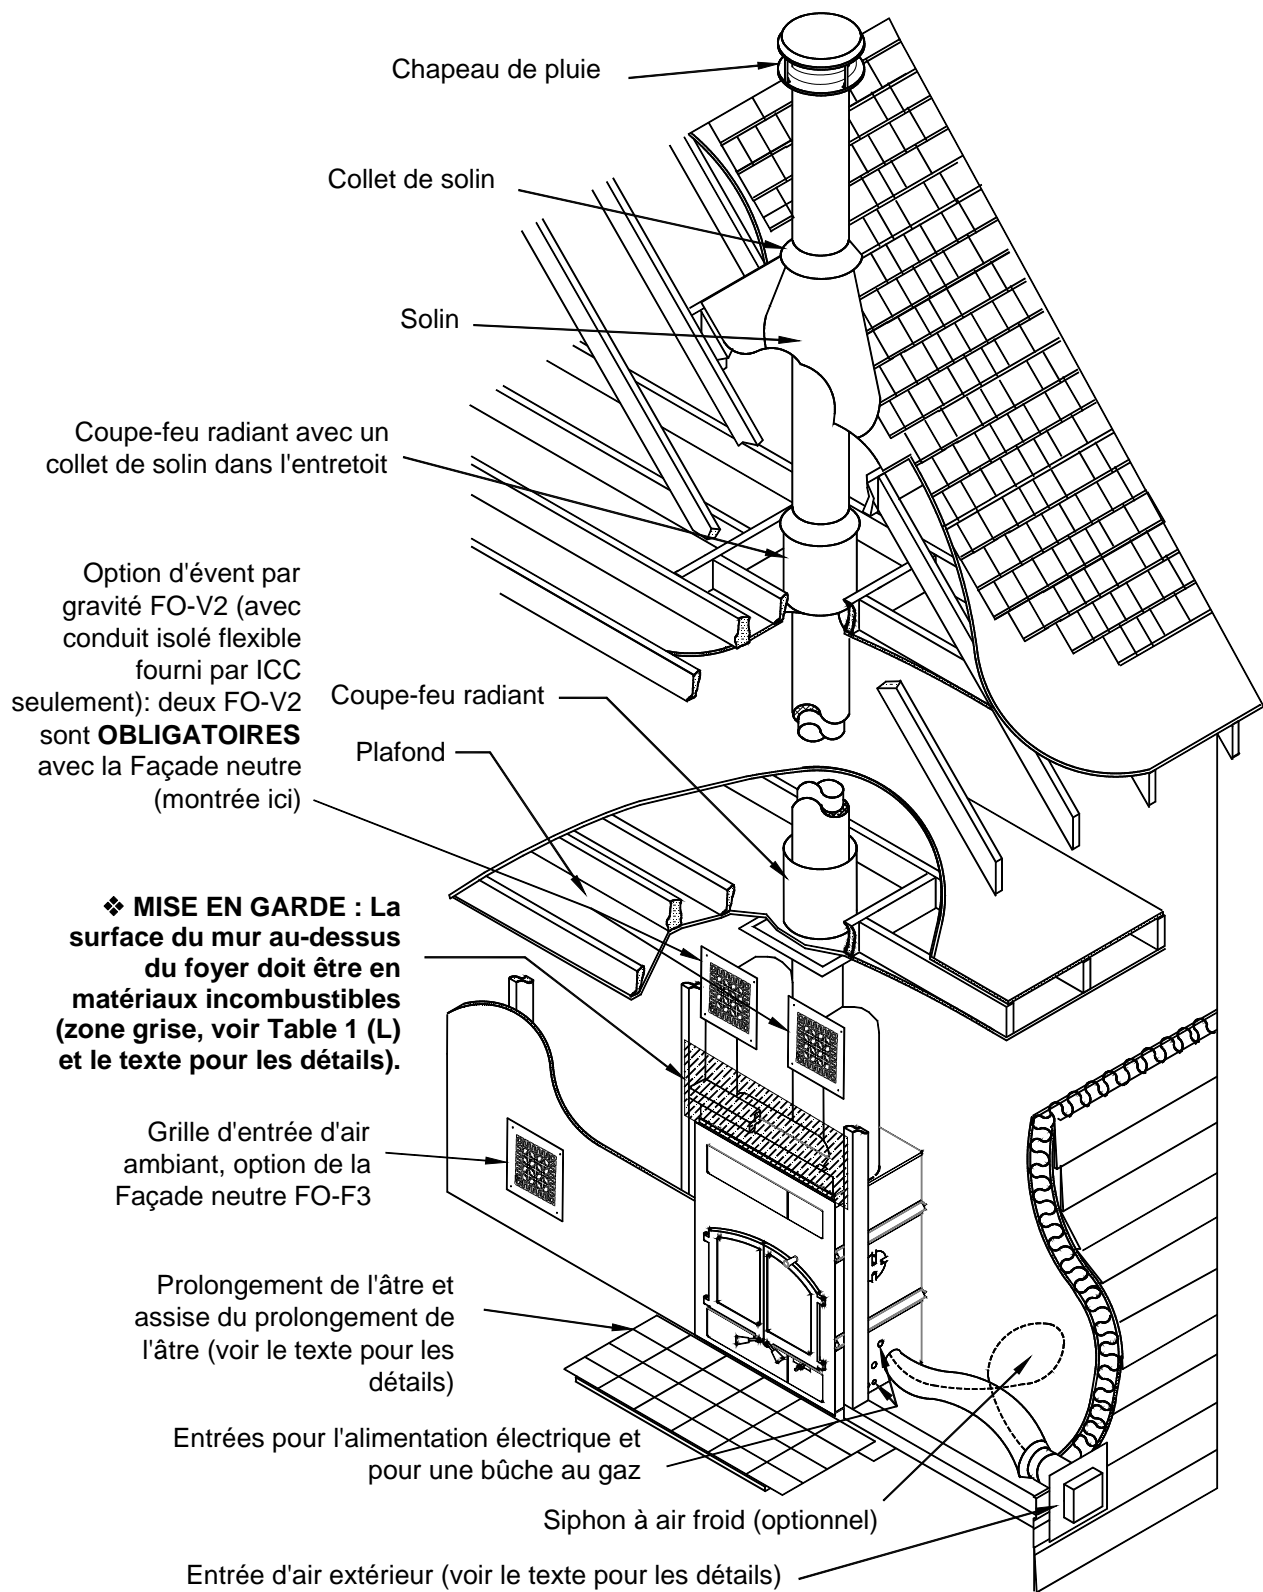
Installation générale pour un foyer OPEL C avec Façade neutre
